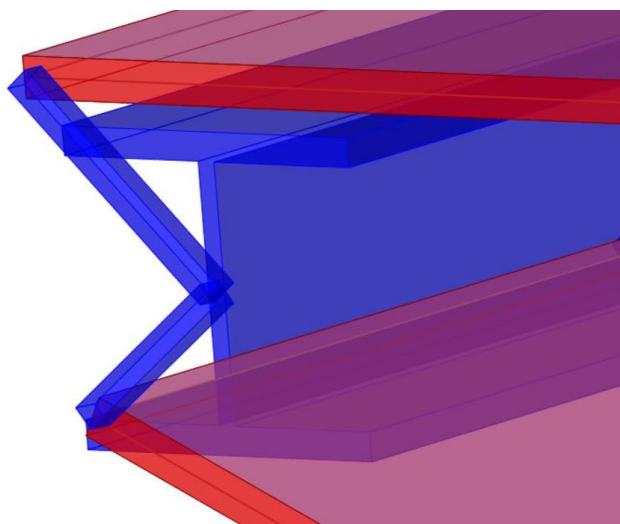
Pormenor da ligação das chapas ao perfil com troços rígidos.
